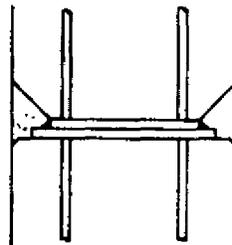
Junta columna-columna (Wakabayashi, 1986).
